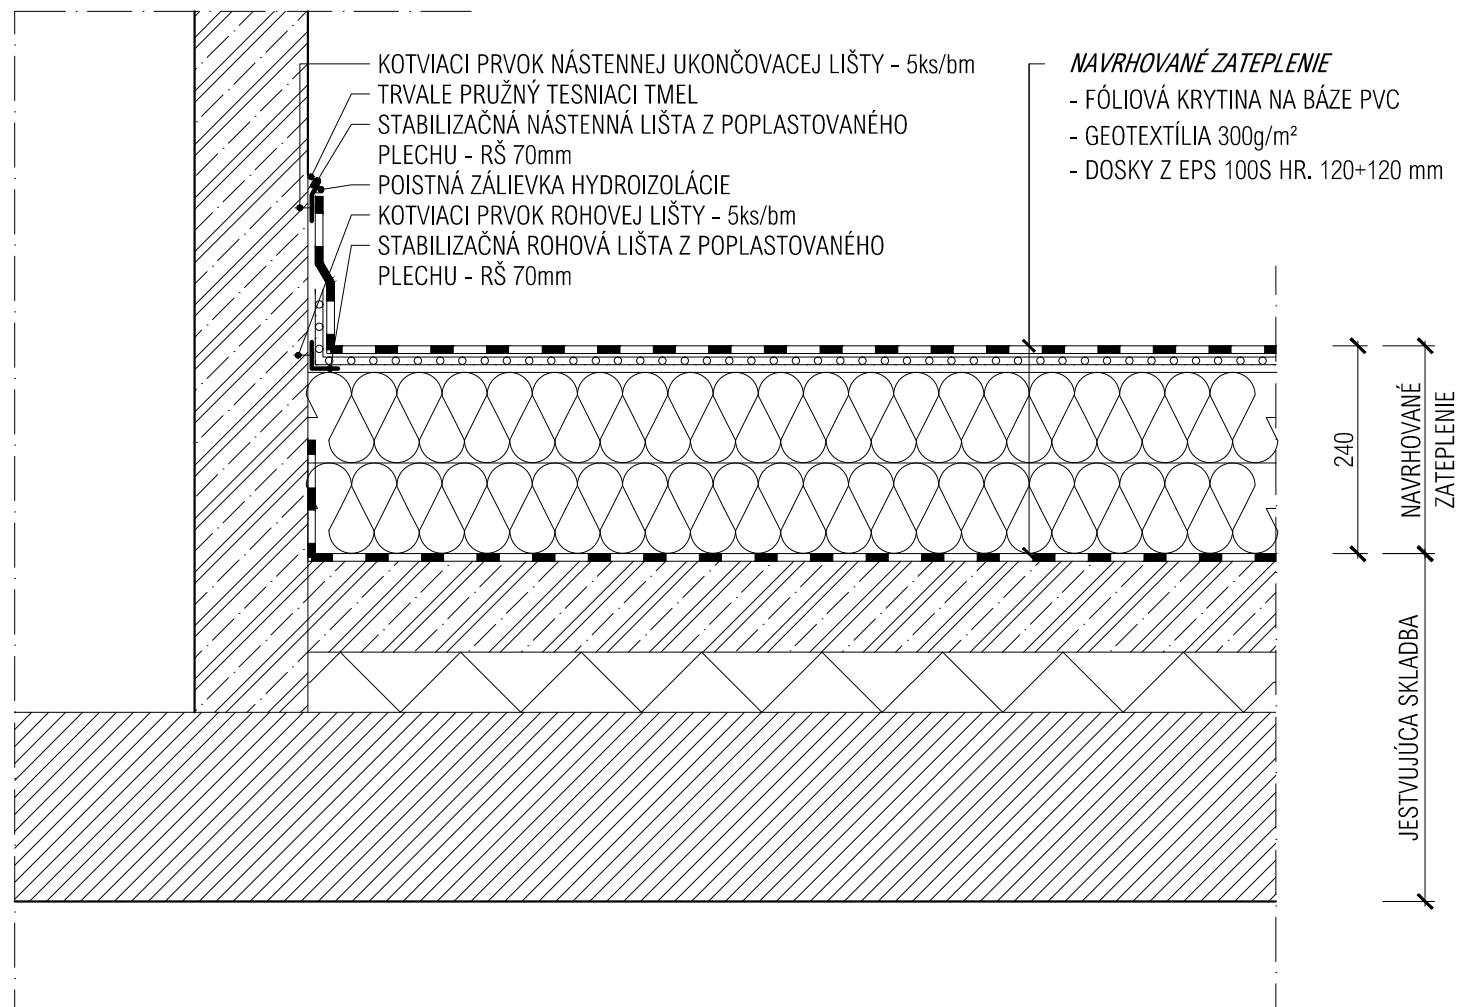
DETAIL ZATEPLENIA KOMÍNA NA STRECHE PRÍZEMNÉHO PAVILÓNU - M1/10
